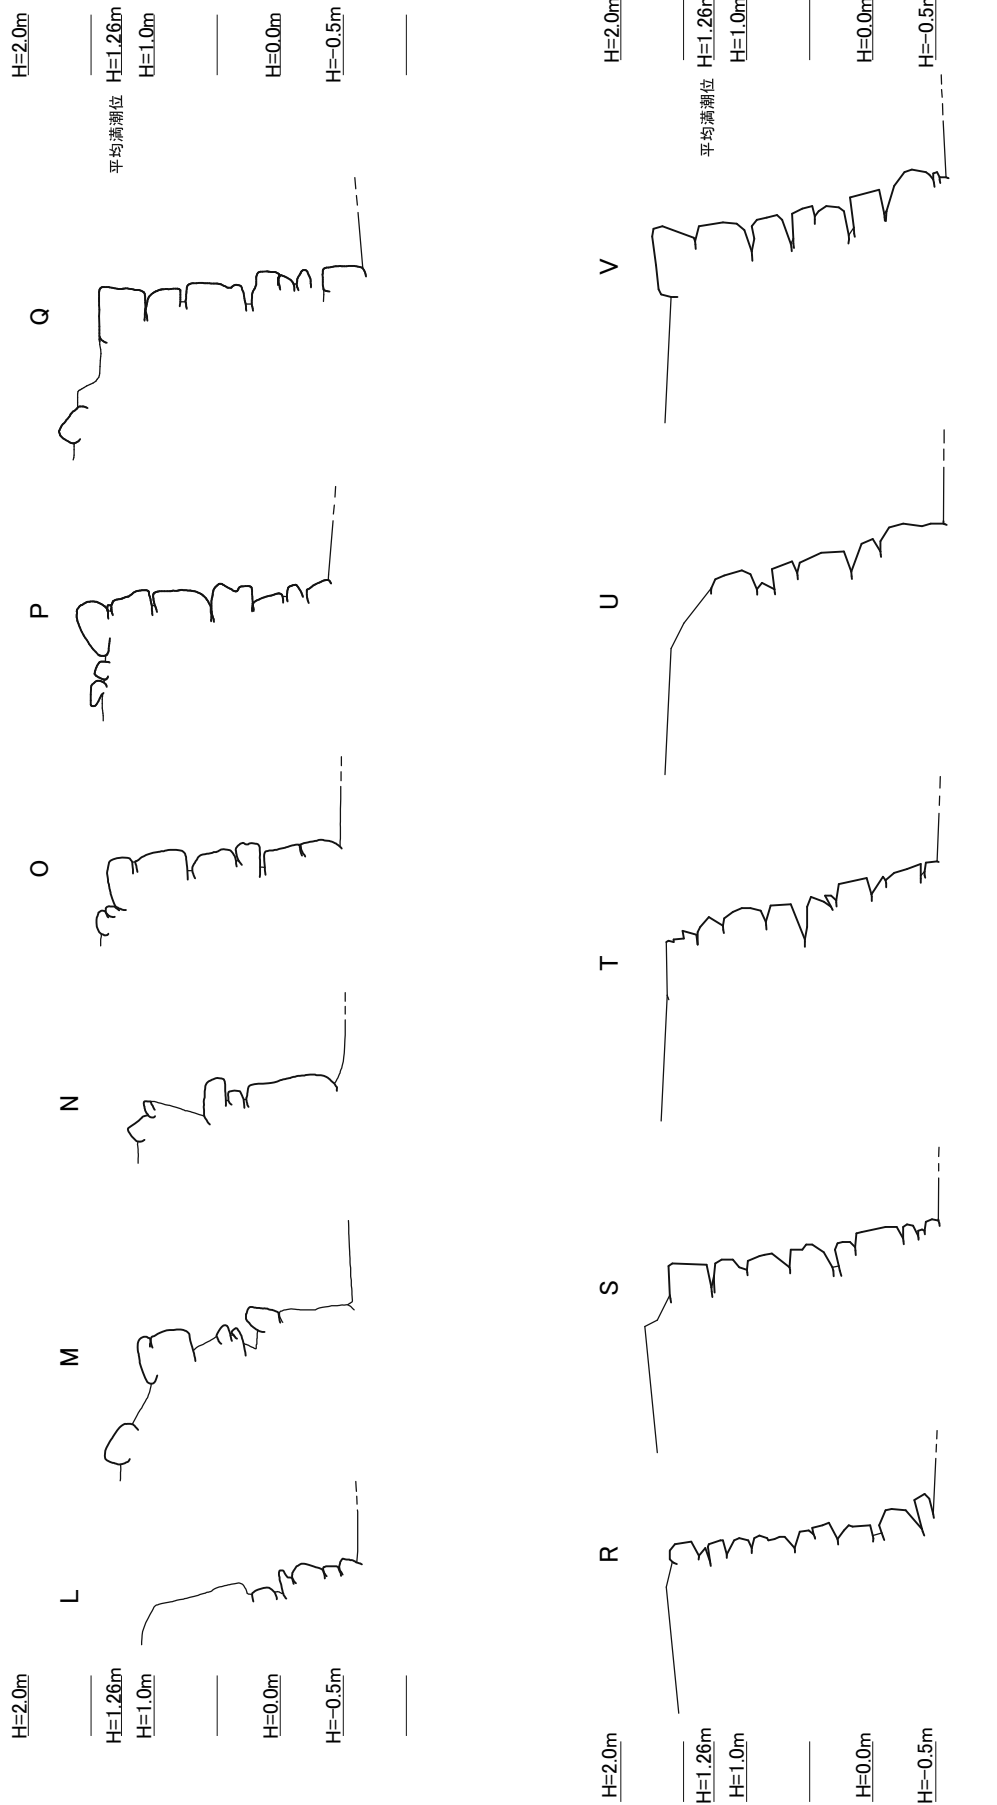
①-2 南侧護岸石垣 断面图 (S=1/60)
